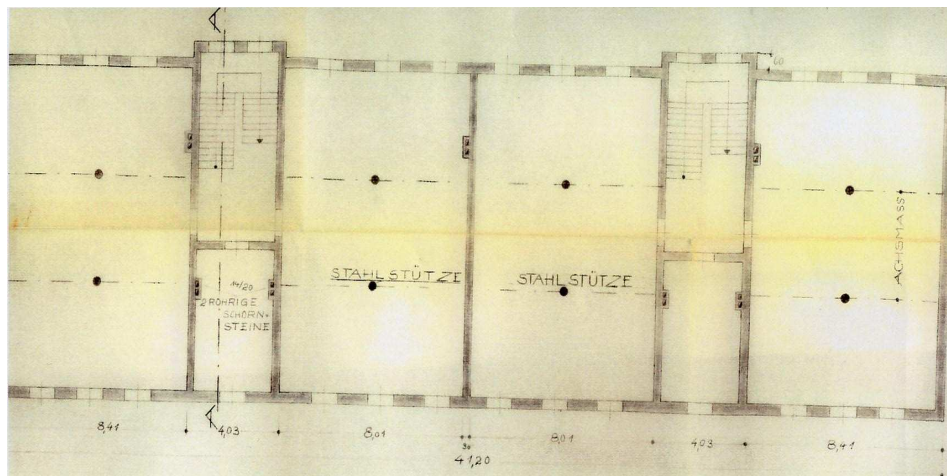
M.1 Erdgeschoß vor dem Umbau, Ausschnitt Umbauplan (undatiert)
